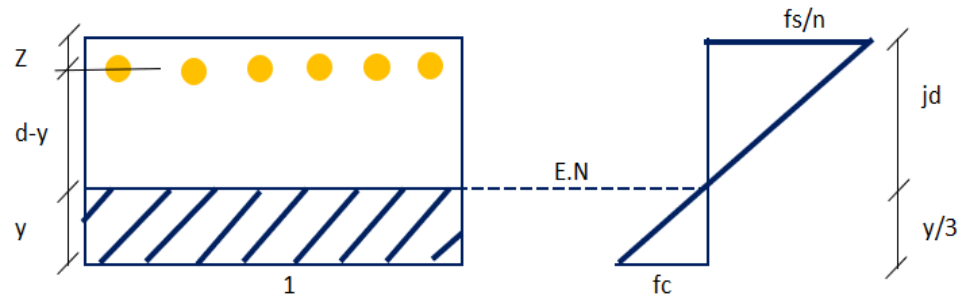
Fisuramiento-fuente: elaboración propia
